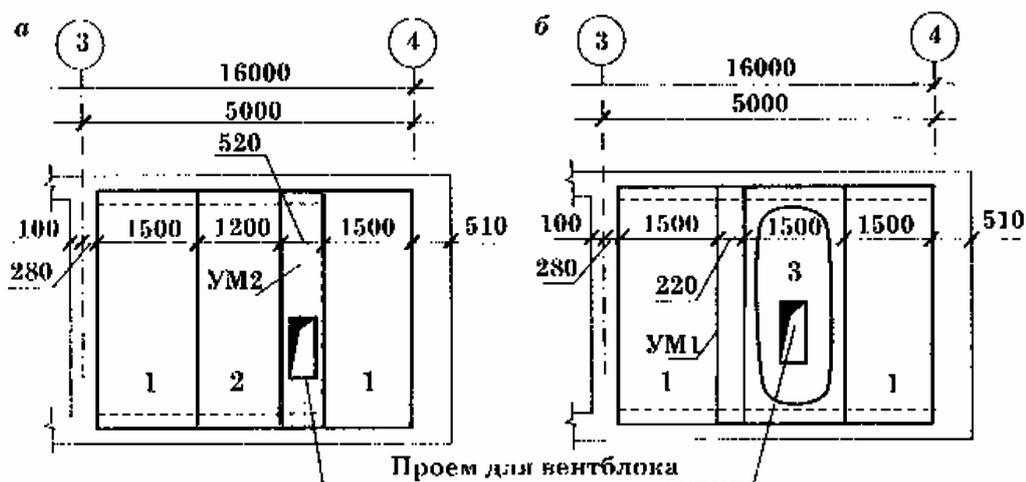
Изображение вентиляционных каналов на плане перекрытий
